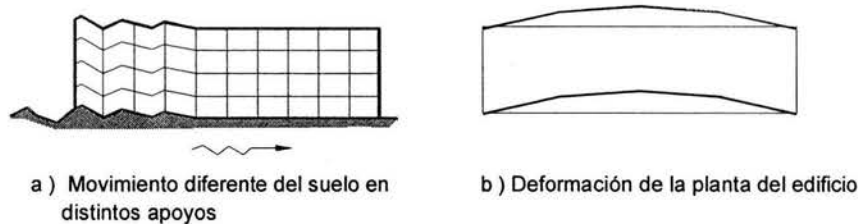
Problemas en edificios demasiado largos en planta (Meli, Bazan 1998)
